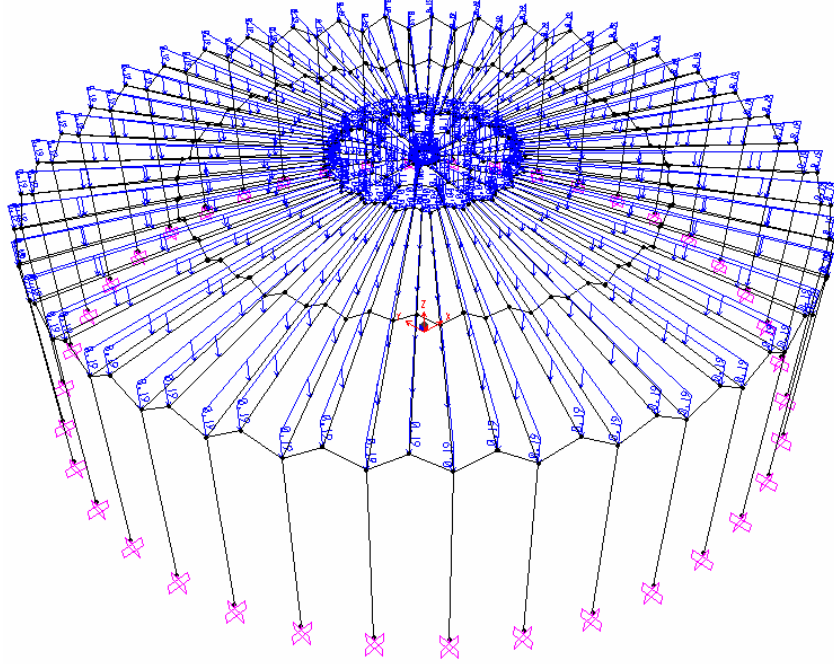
Yapı Statik Modeli Plan Görünüşü
